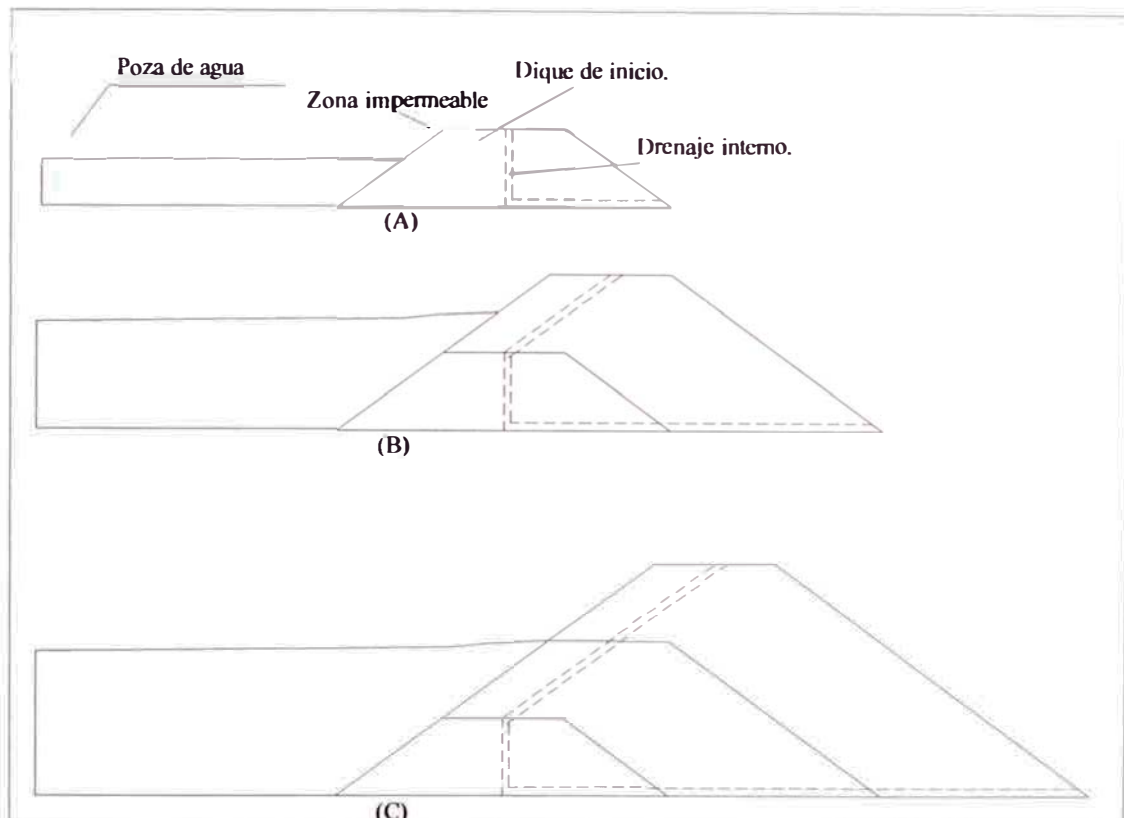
Secuencia de sobre elevación. Presa construida con el método “Aguas Abajo” y dren de chimenea.
